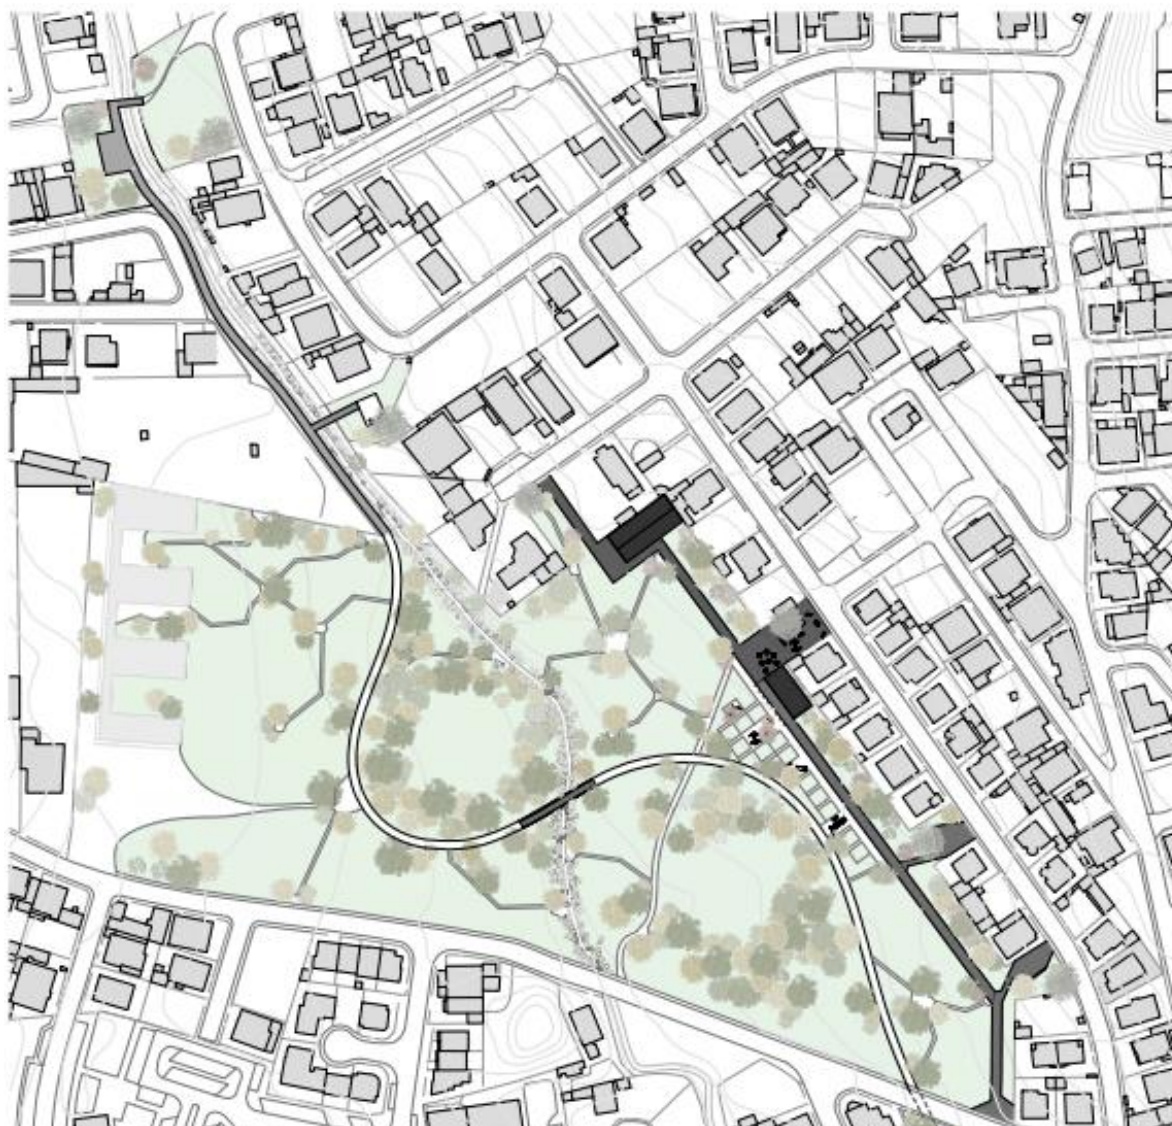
Planta de Implantação (redução da escala 1/1000)
